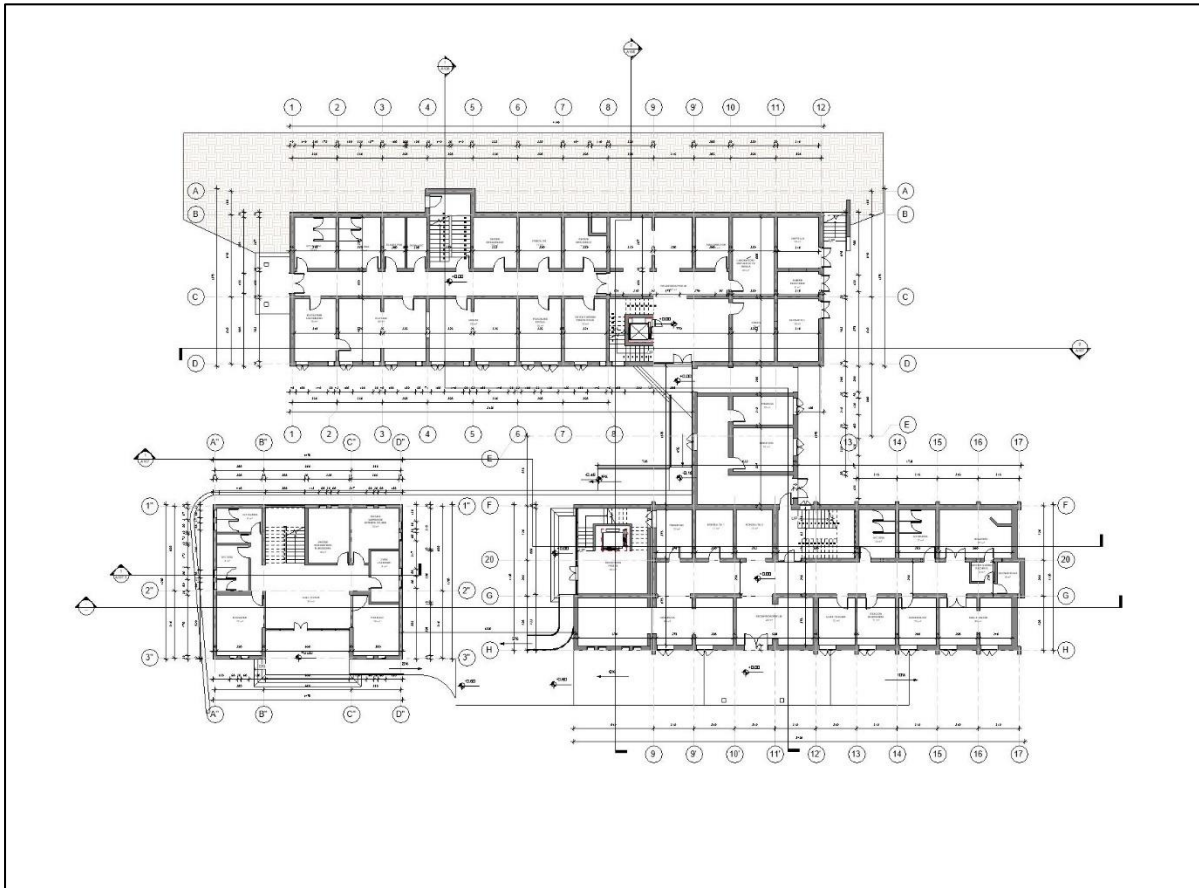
Planimetria e Propozuar e Katit Përdhe [0]
